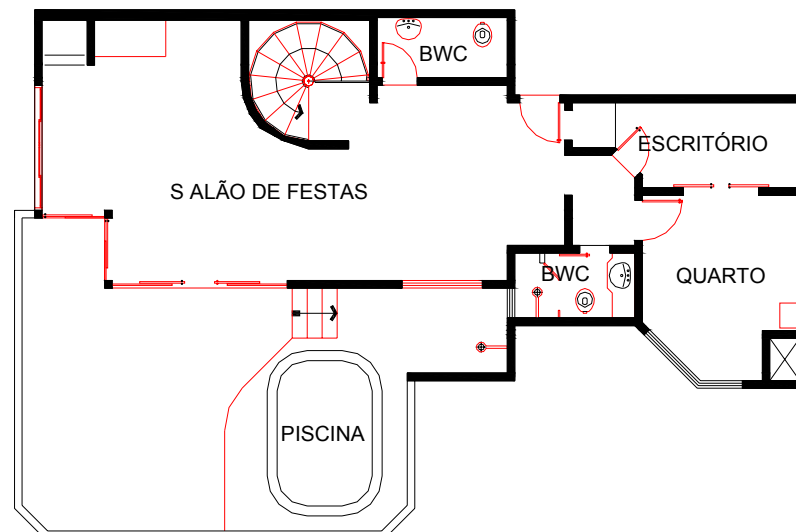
Planta Baixa do pavimento superior do apartamento 1002 – Estudo de caso B. (Apartamento Duplex).
